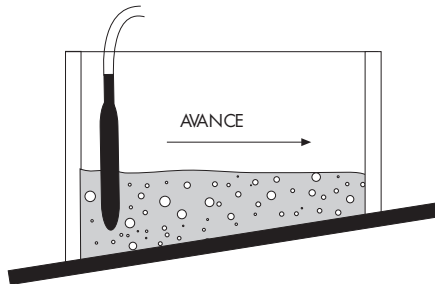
Hormigón colocado en elemento con fondo en pendiente; tanto la colocación como la compactación deben iniciarse en las zonas de menor cota.
